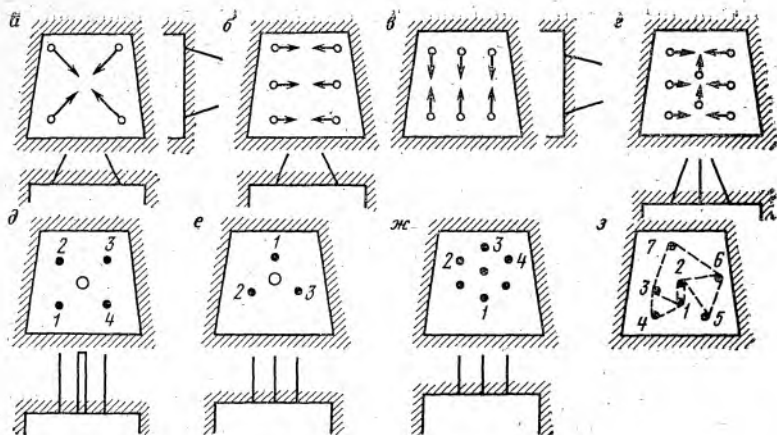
Врубы, применяемые при проходке горизонтальных выработок подземных хранилищ:
